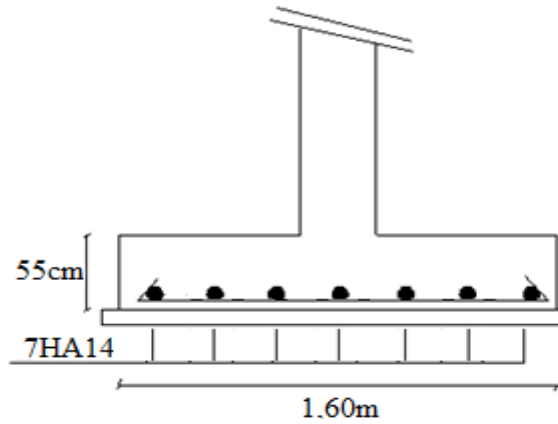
Ferrailage de la semelle intermédiaire dans le sens x-x.
